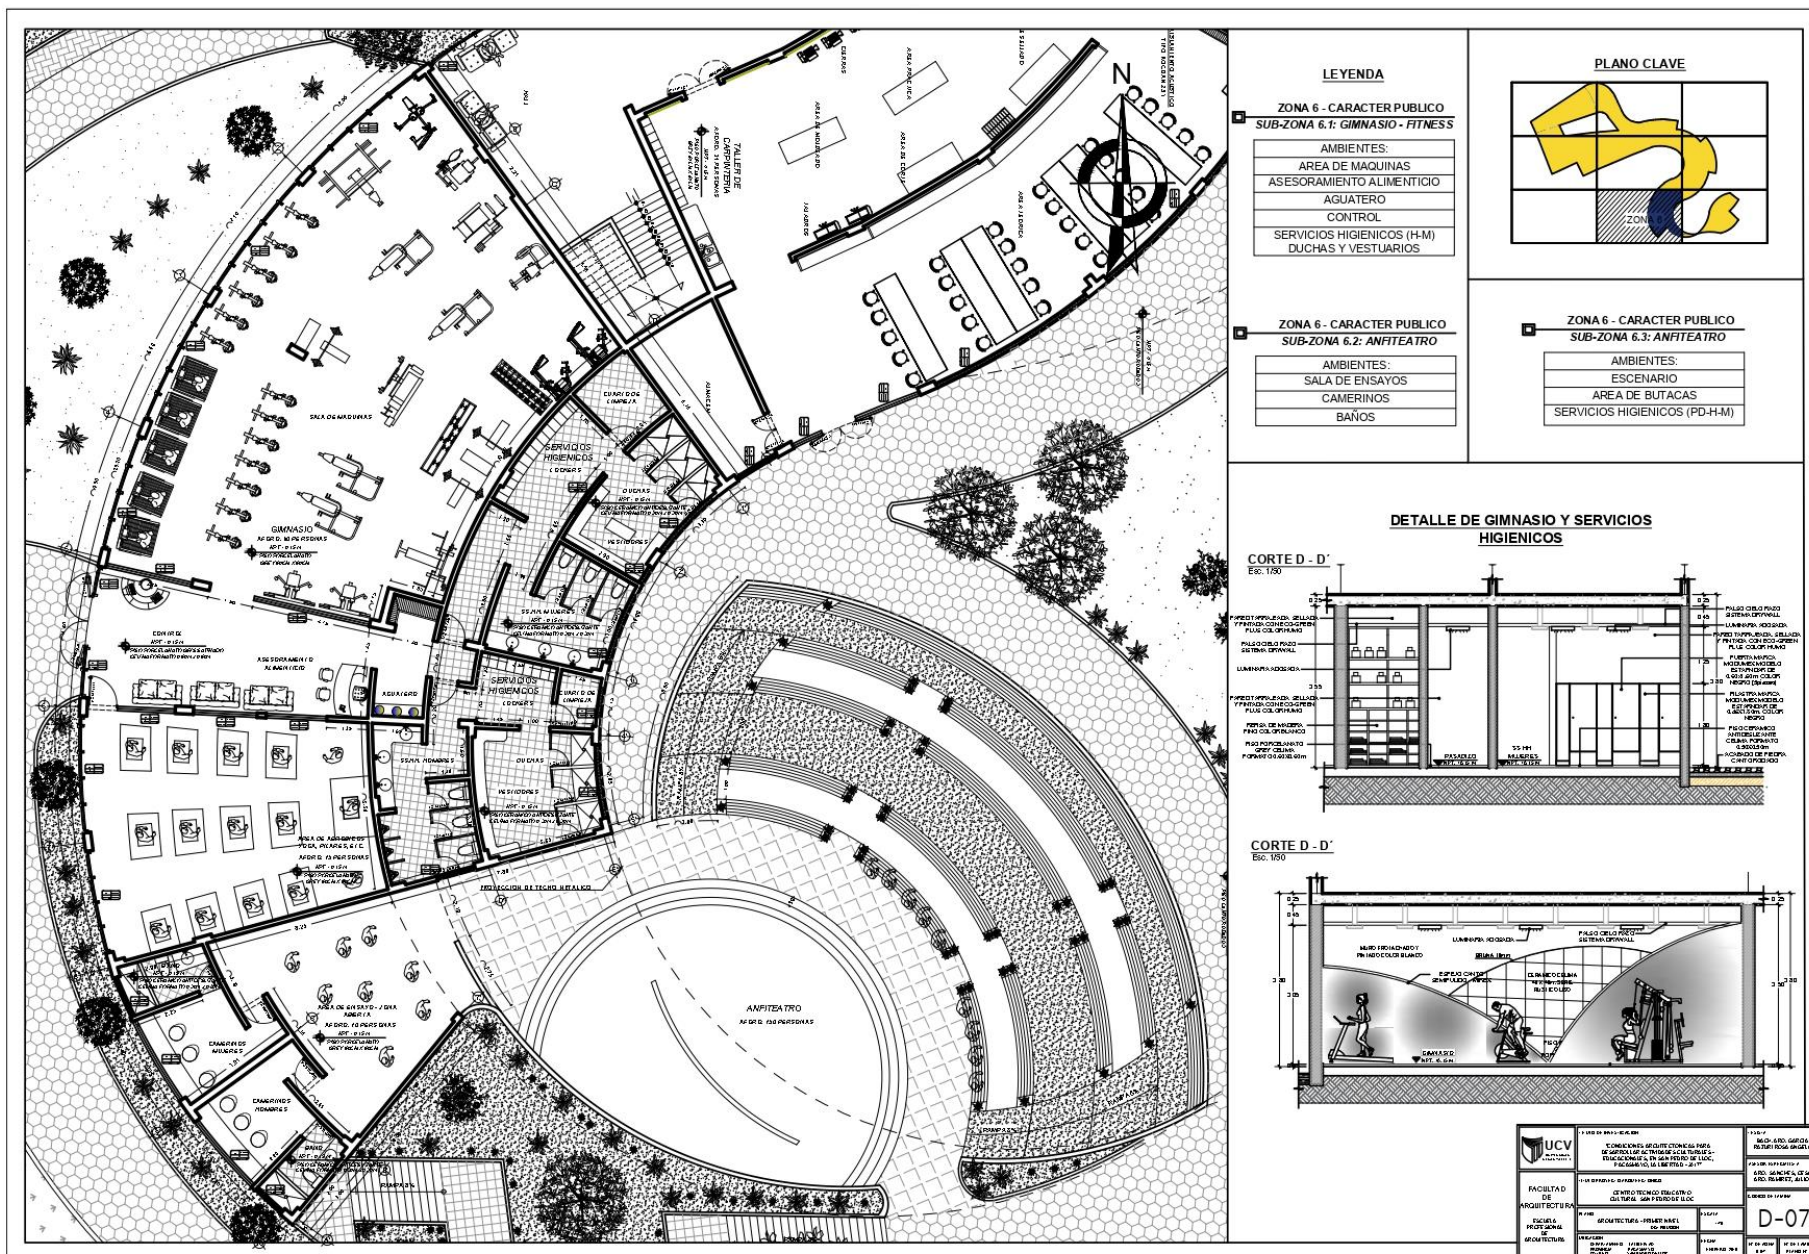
Plano de Desarrollo por Zonas - Plano N° 14 - Lamina N°: D - 06
